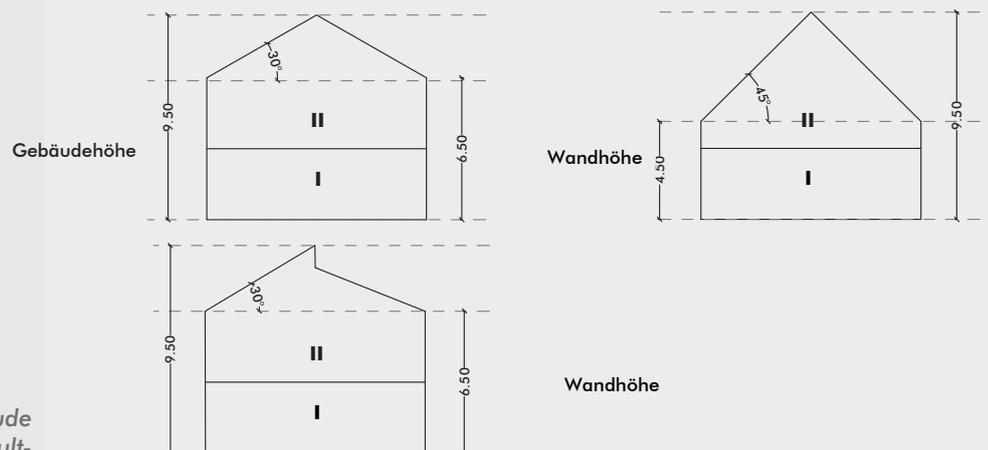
Schemaschnitt Gebäude mit Satteldach und versetztem Pultdach, unmaßstäblich
